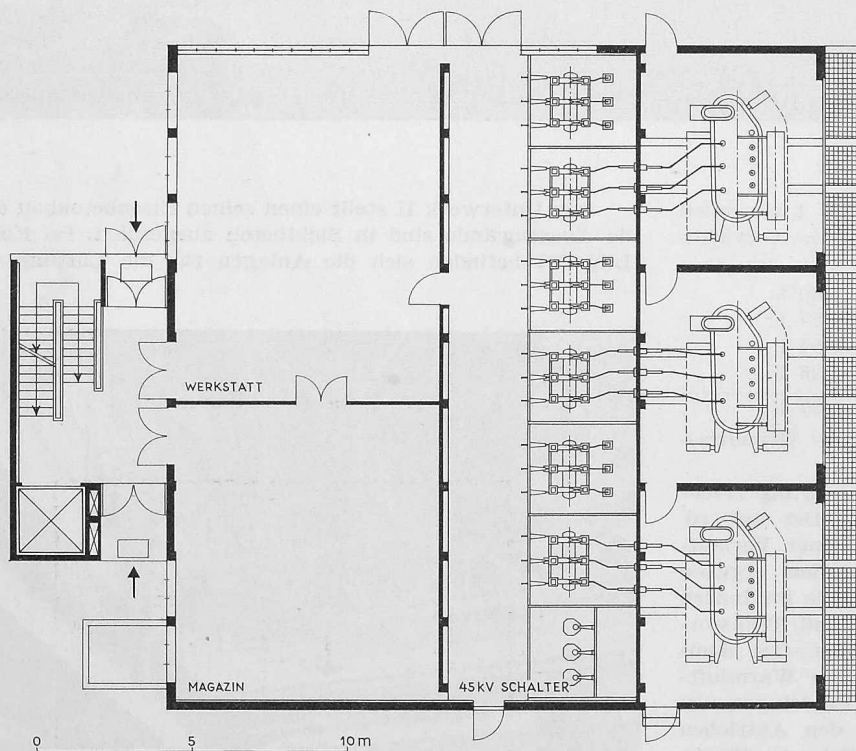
Erdgeschossgrundriss des Unterwerkes II, 1:250
